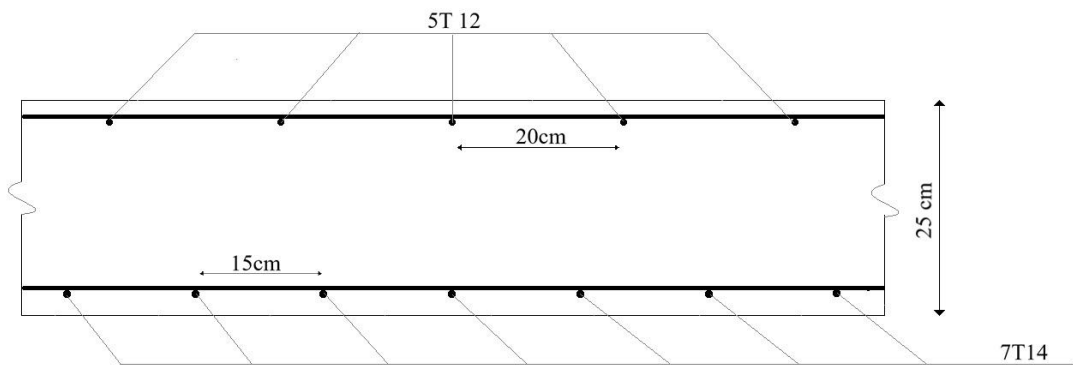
schéma de Ferrailage de l'hourdis dans le sens longitudinal
